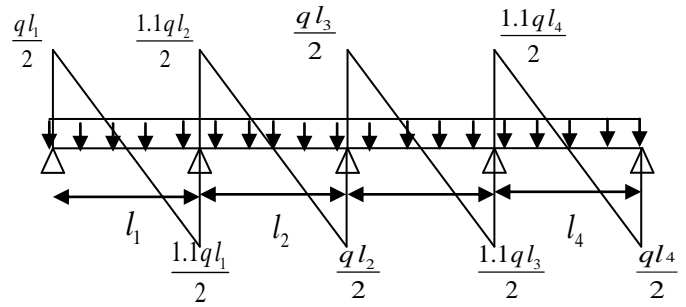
Effort tranchant d'une poutre à plus de 2 travées
